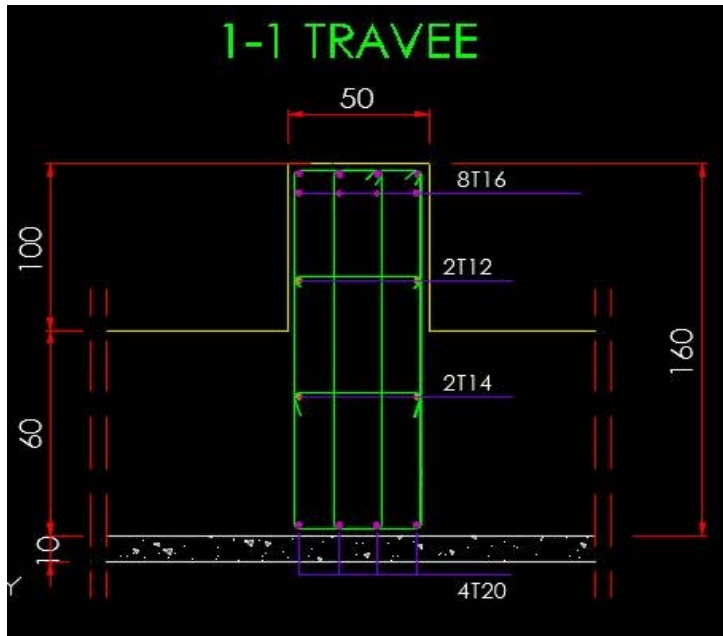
Coupe De Ferrailage De Libage (travée)
